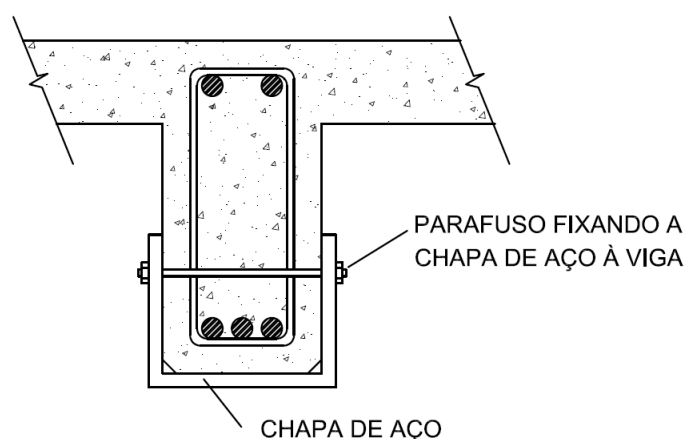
Detalhe de fixação de chapa de aço sob a viga. (DELTACON, 2011)
